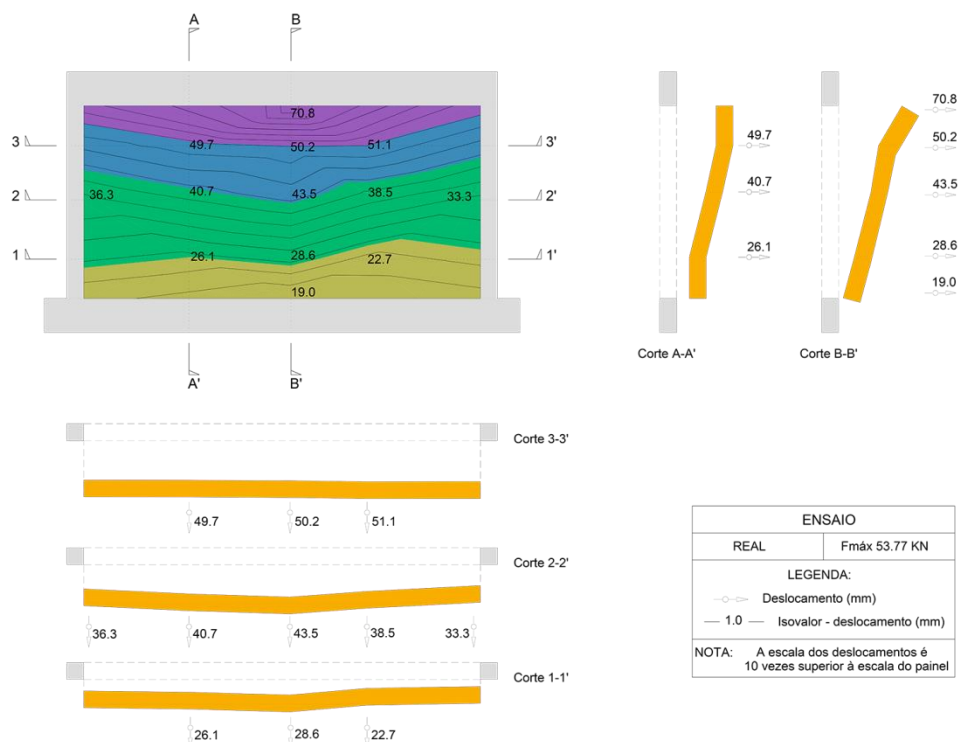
Isovalores da parede ensaiada - Cargas localizadas. Ensaio fora do plano, Wall_RAR_01.
